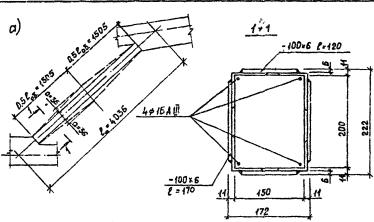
Схема усиления сжатого раскоса фермы металлической обоймой с напряженными ветвями:
